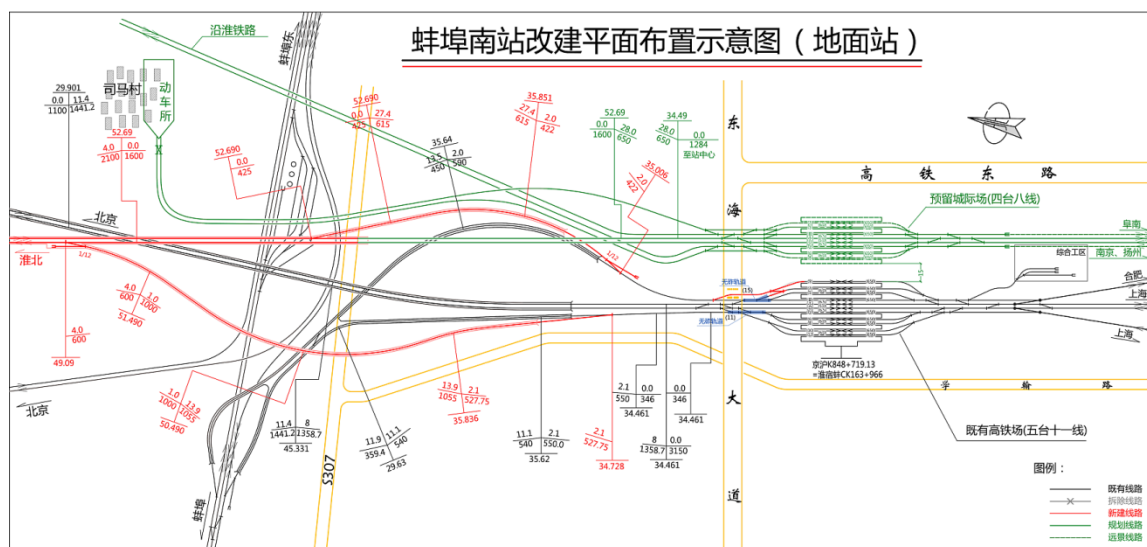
蚌埠南站改建平面布置示意图（含孙郢线路所）
